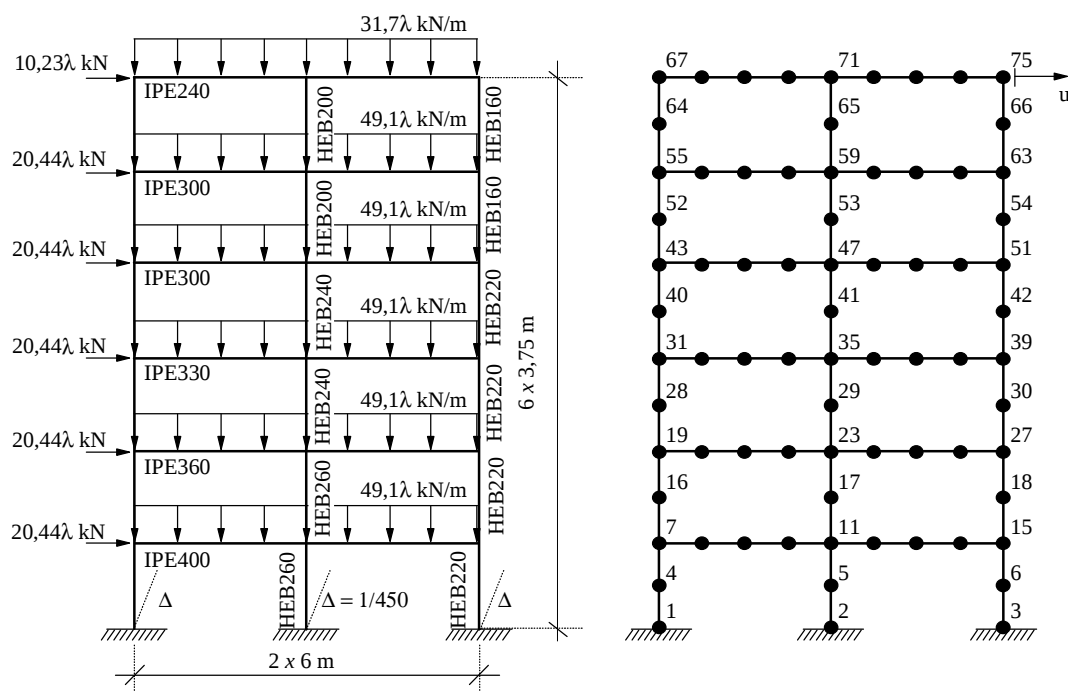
Pórtico de 6 andares: geometria, carregamentos e discretização adotada
